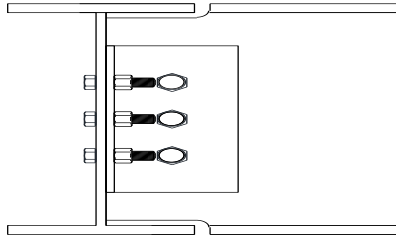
Detalle típico de conexión atornillada en viga tipo I.
